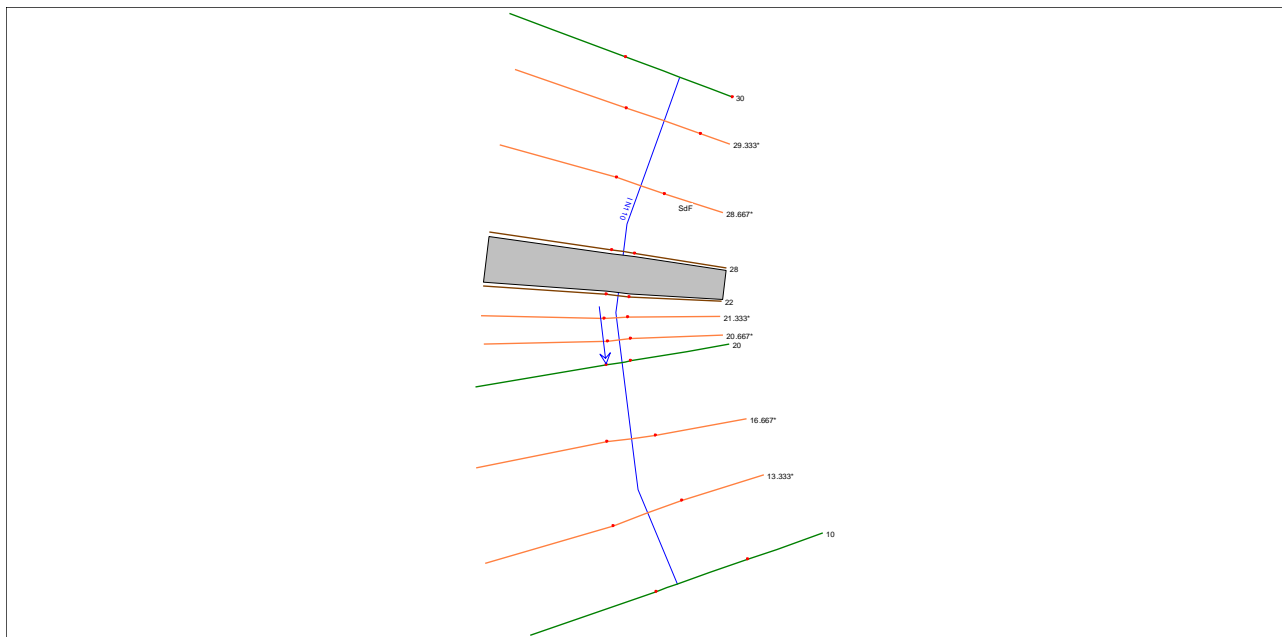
Planimetria modello 1D – stato di progetto interferenza IN110.
